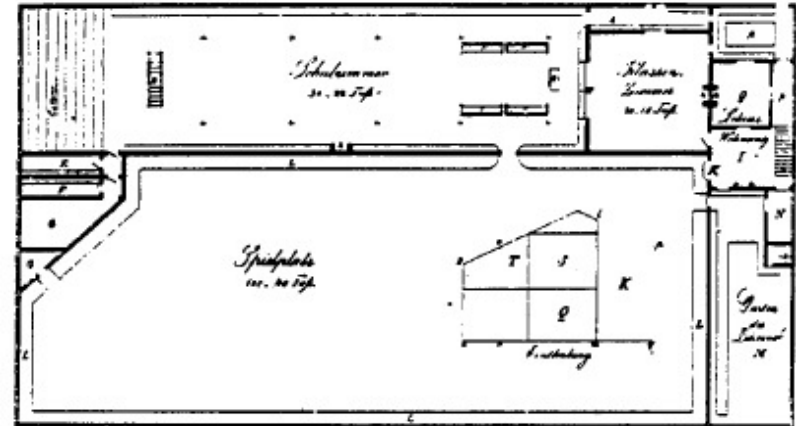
Grundriss einer Kleinkinderschule nach S. Wilderspien
